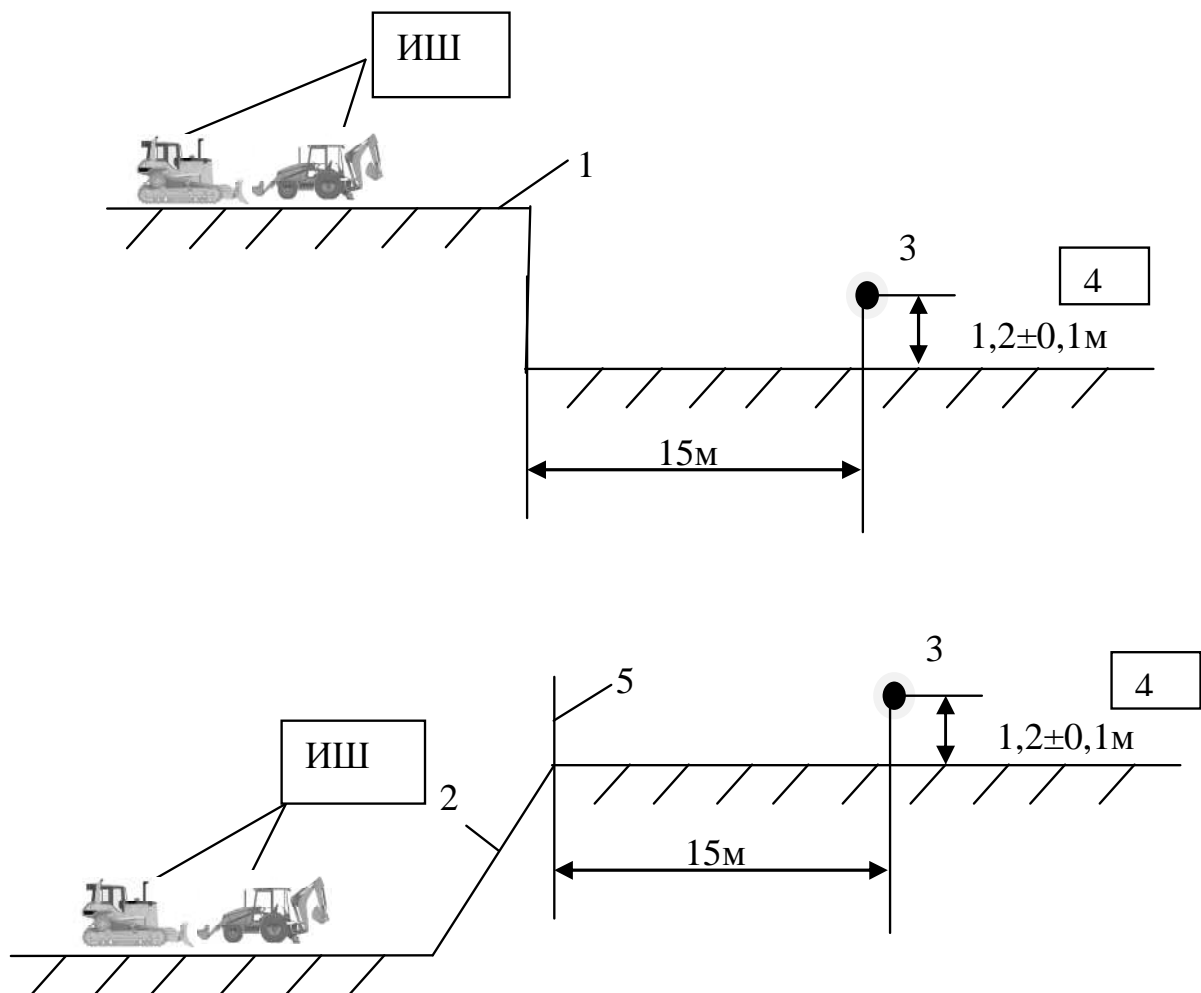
Схема расположения измерительных точек: а) для строительных площадок на эстакаде (насыпи), б) для строительных площадок в выемке; 1 – эстакада (насыпь), 2 – выемка, 3 – измерительная точка, 4 – жилая застройка, 5 – край выемки, ИШ – источник шума.
